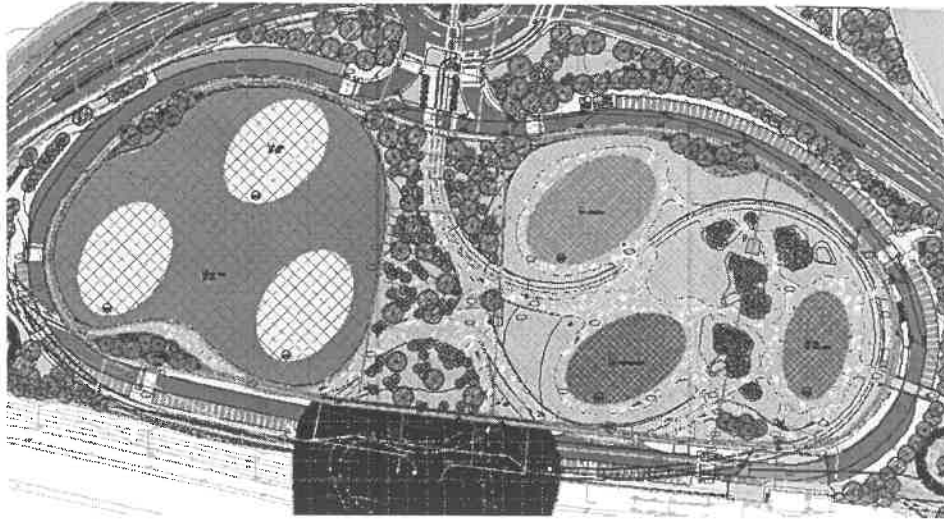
Extrato da Planta de Síntese – Lotes em pormenor (Desenhos A-08A/A-08B/A-08C) – Req.º 22164/2019 (Ficheiro LOT.22.dwf)
